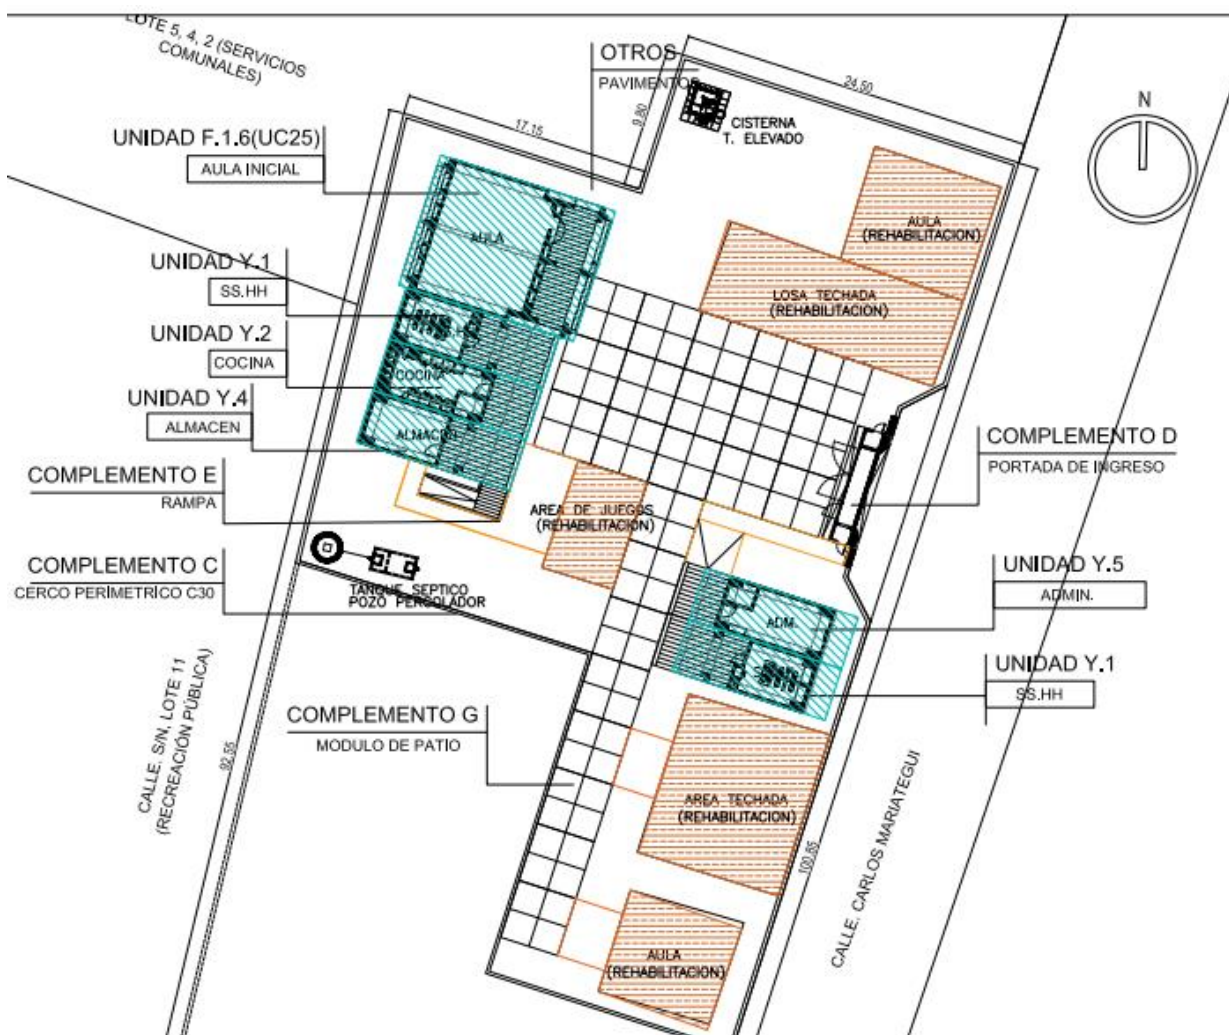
IE 816- CL 770278 – Planteamiento de Cabida desarrollado por el equipo UGRD.
